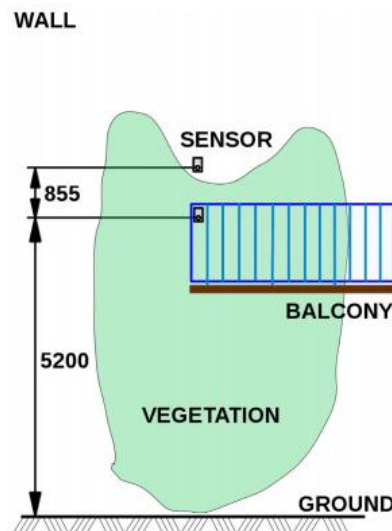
Fachada onde a vegetação está aplicada, juntamente com a localização dos sensores (Antonyová, Antony e Korjenic, 2017)
